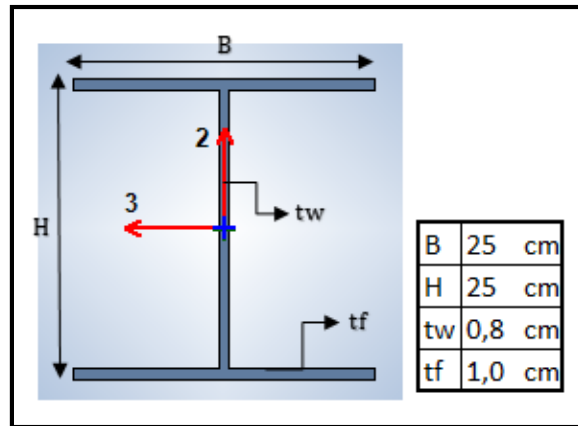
Dimensiones, Columna 2 con pórticos resistentes a momento.
